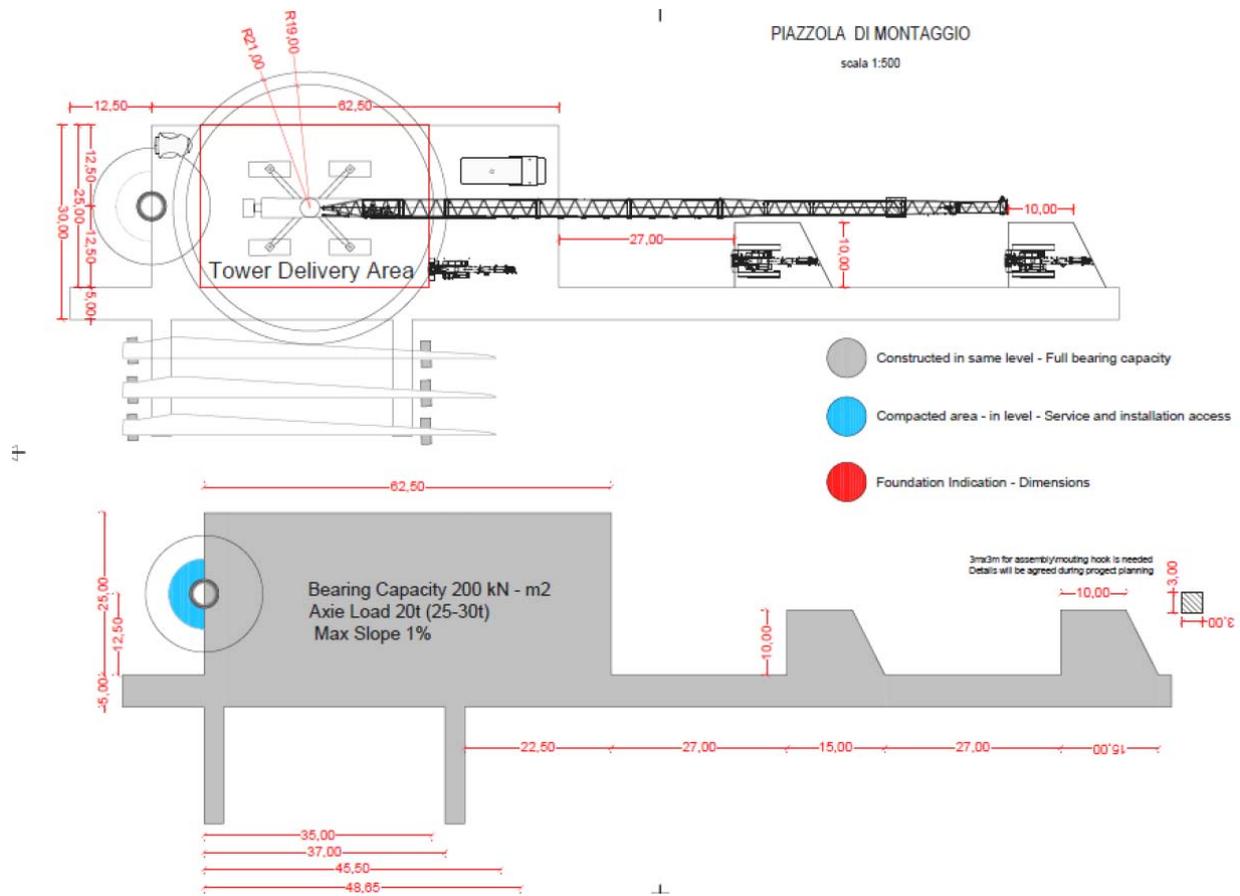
Planimetria recante il dettaglio della piazzola per il montaggio degli aerogeneratori
